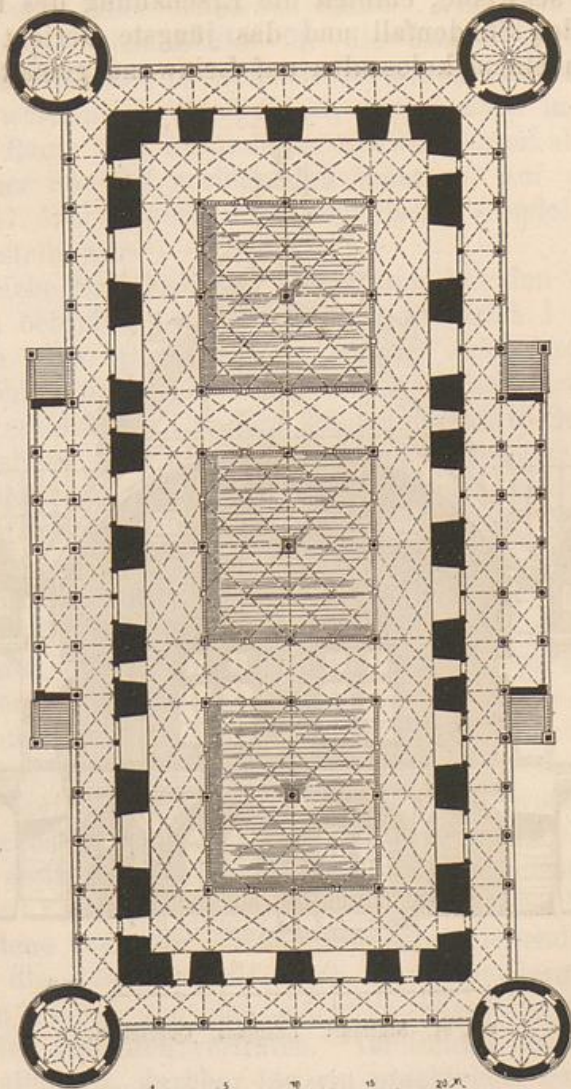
Lusthaus zu Stuttgart. Grundriss.
